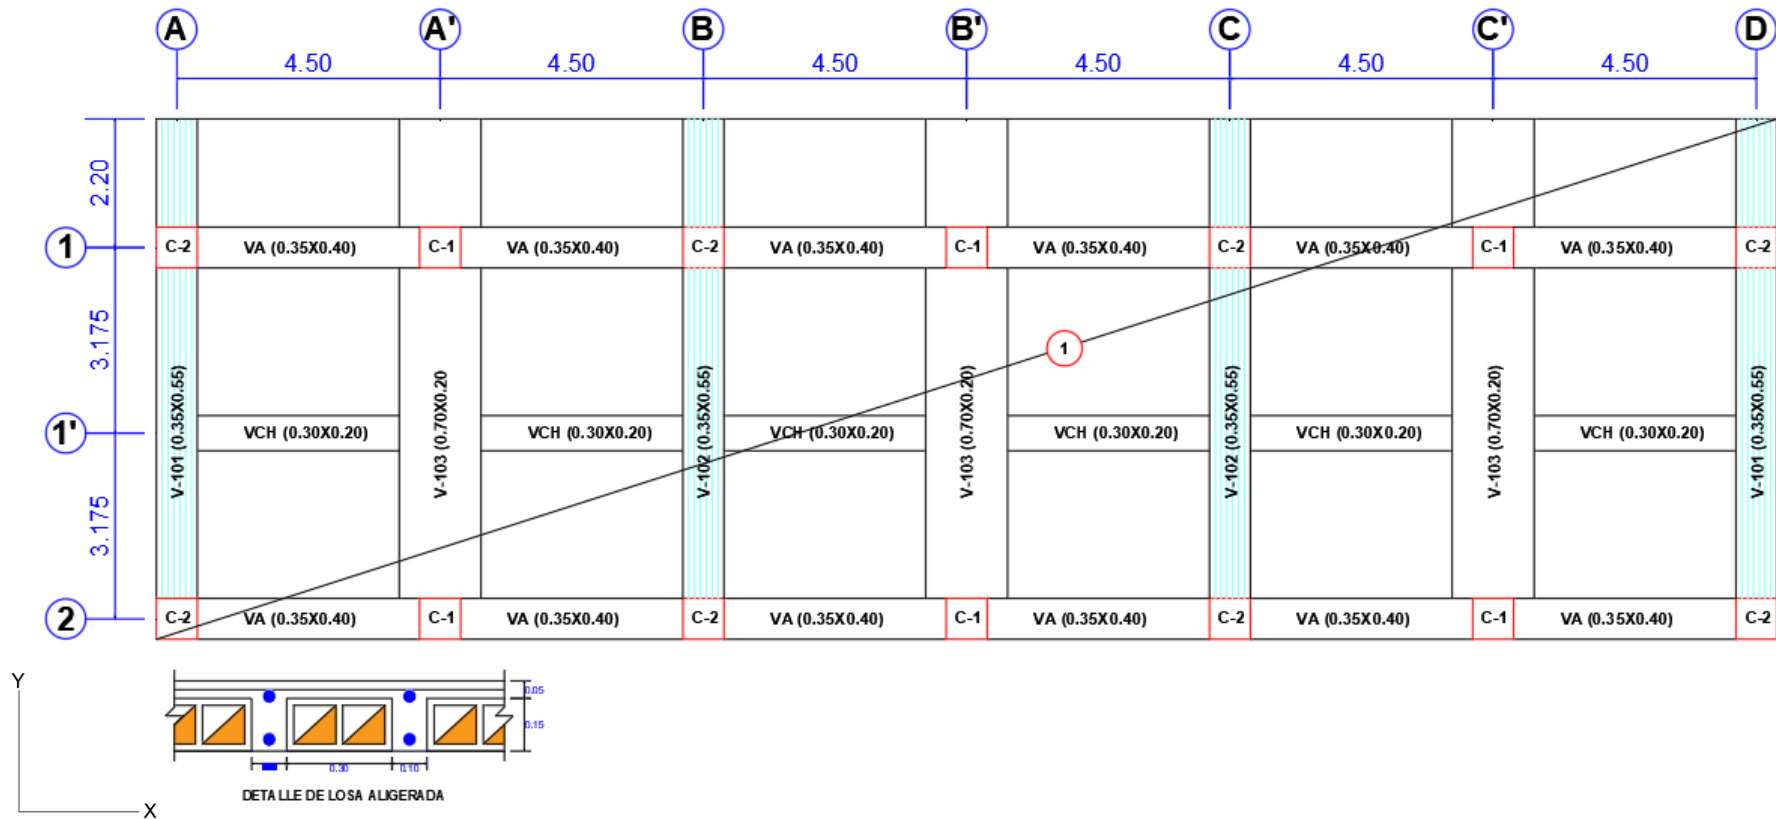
Distribución de los elementos estructurales del Primer Nivel (Fuente: Archivos del Área de Archivo Central, de las obras ejecutadas en la Universidad Nacional de San Martín – Tarapoto)
